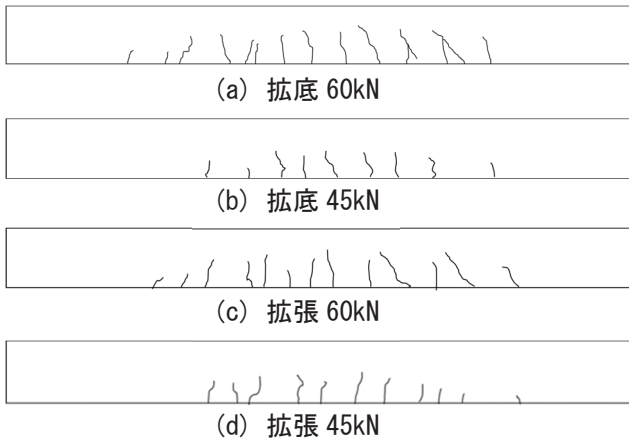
曲げ荷重による曲げひび割れ (RC 梁側面)
